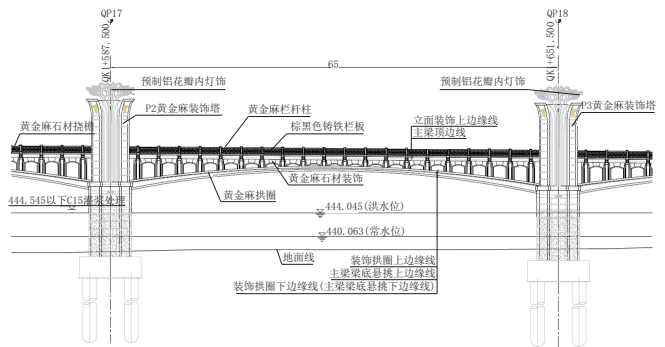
乾峰大桥主桥主跨装饰立面布置图(单位:m)
